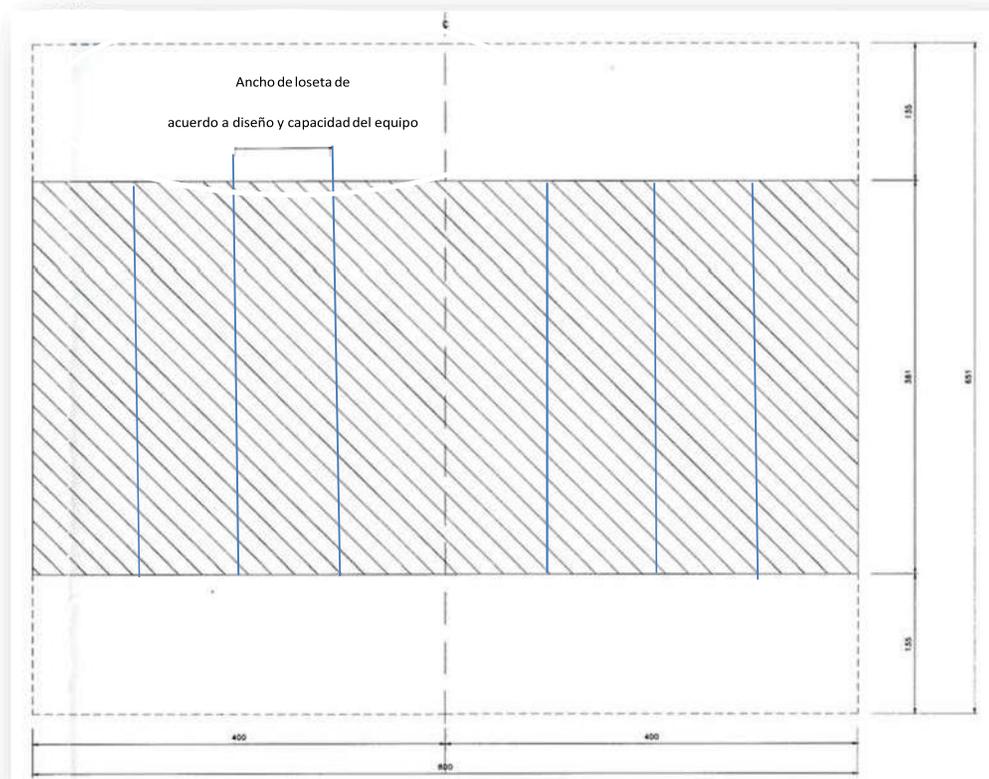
Planta de la pasada con dimensiones sugeridas.
